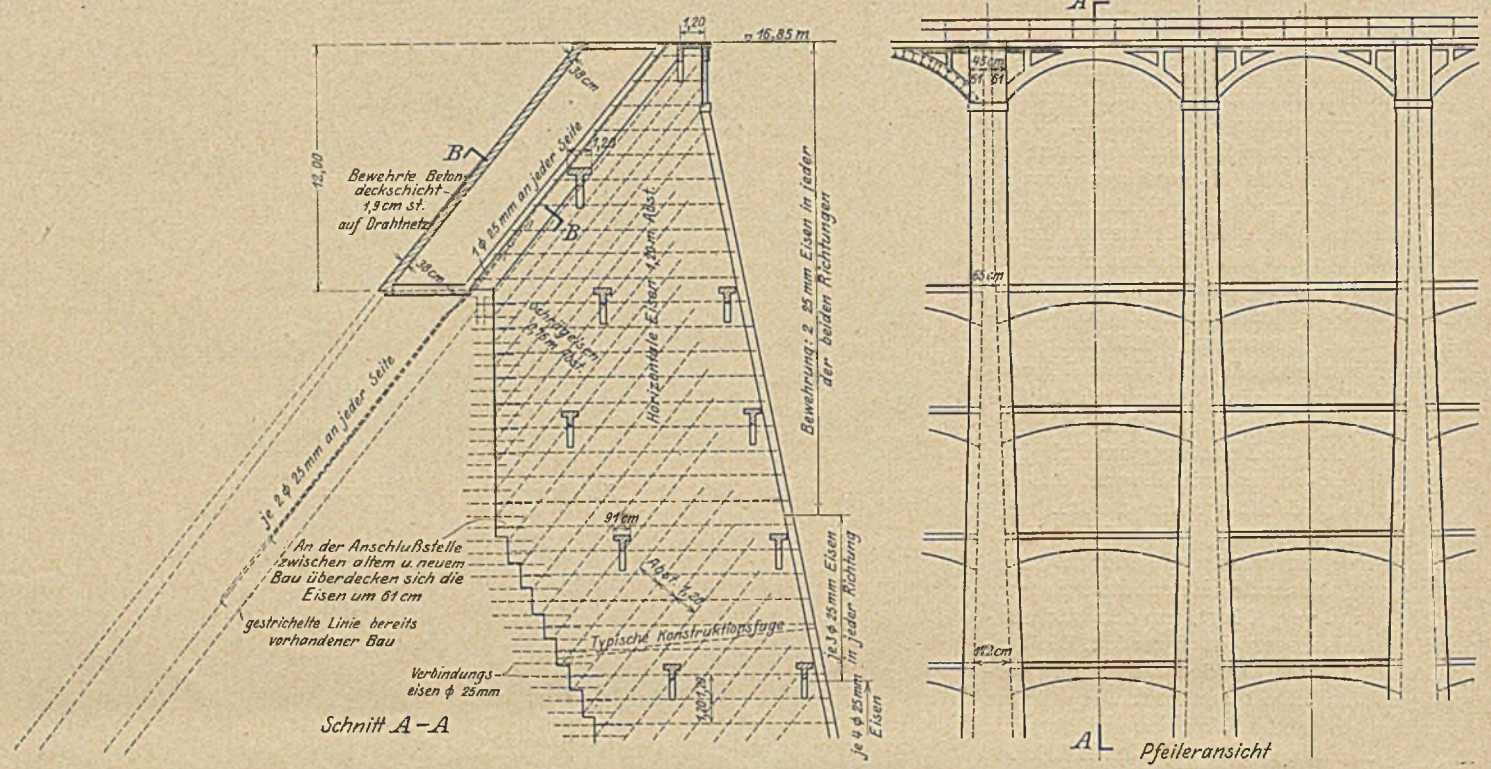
d. Verstärkungen einer Eisenbetontalsperre.
